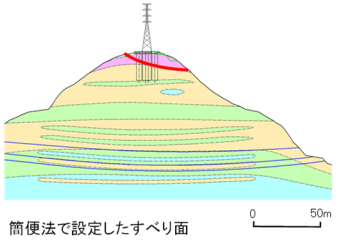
解析モデル図 (B-B' 断面)
